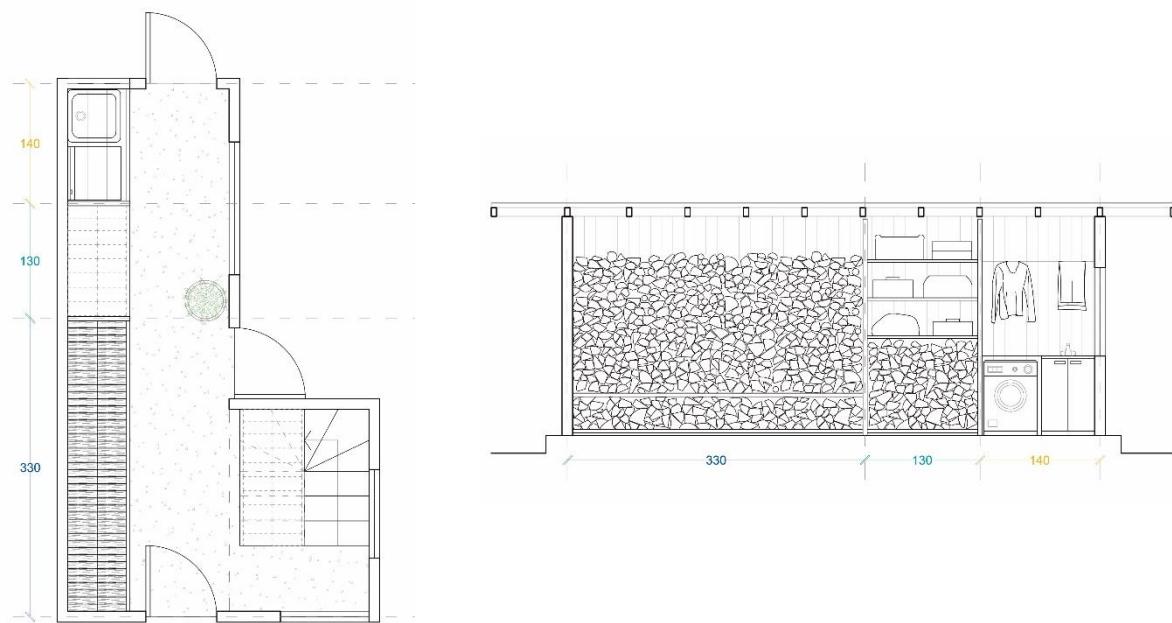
Espacio intermedio: Planta y elevación tercios distribución. *Elaboración propia.
